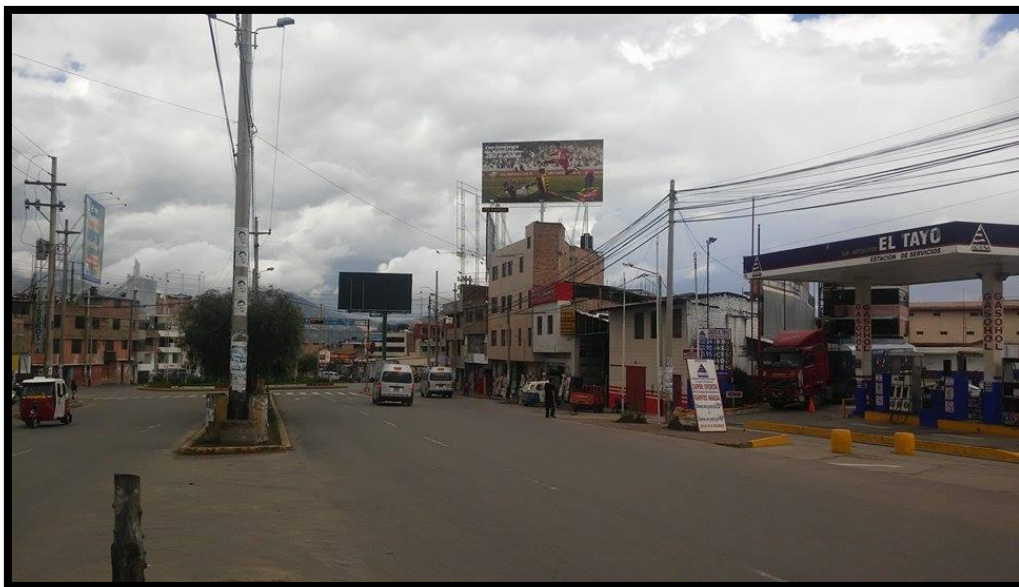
(AV.ATAHUALPA VISTA NORTE)
